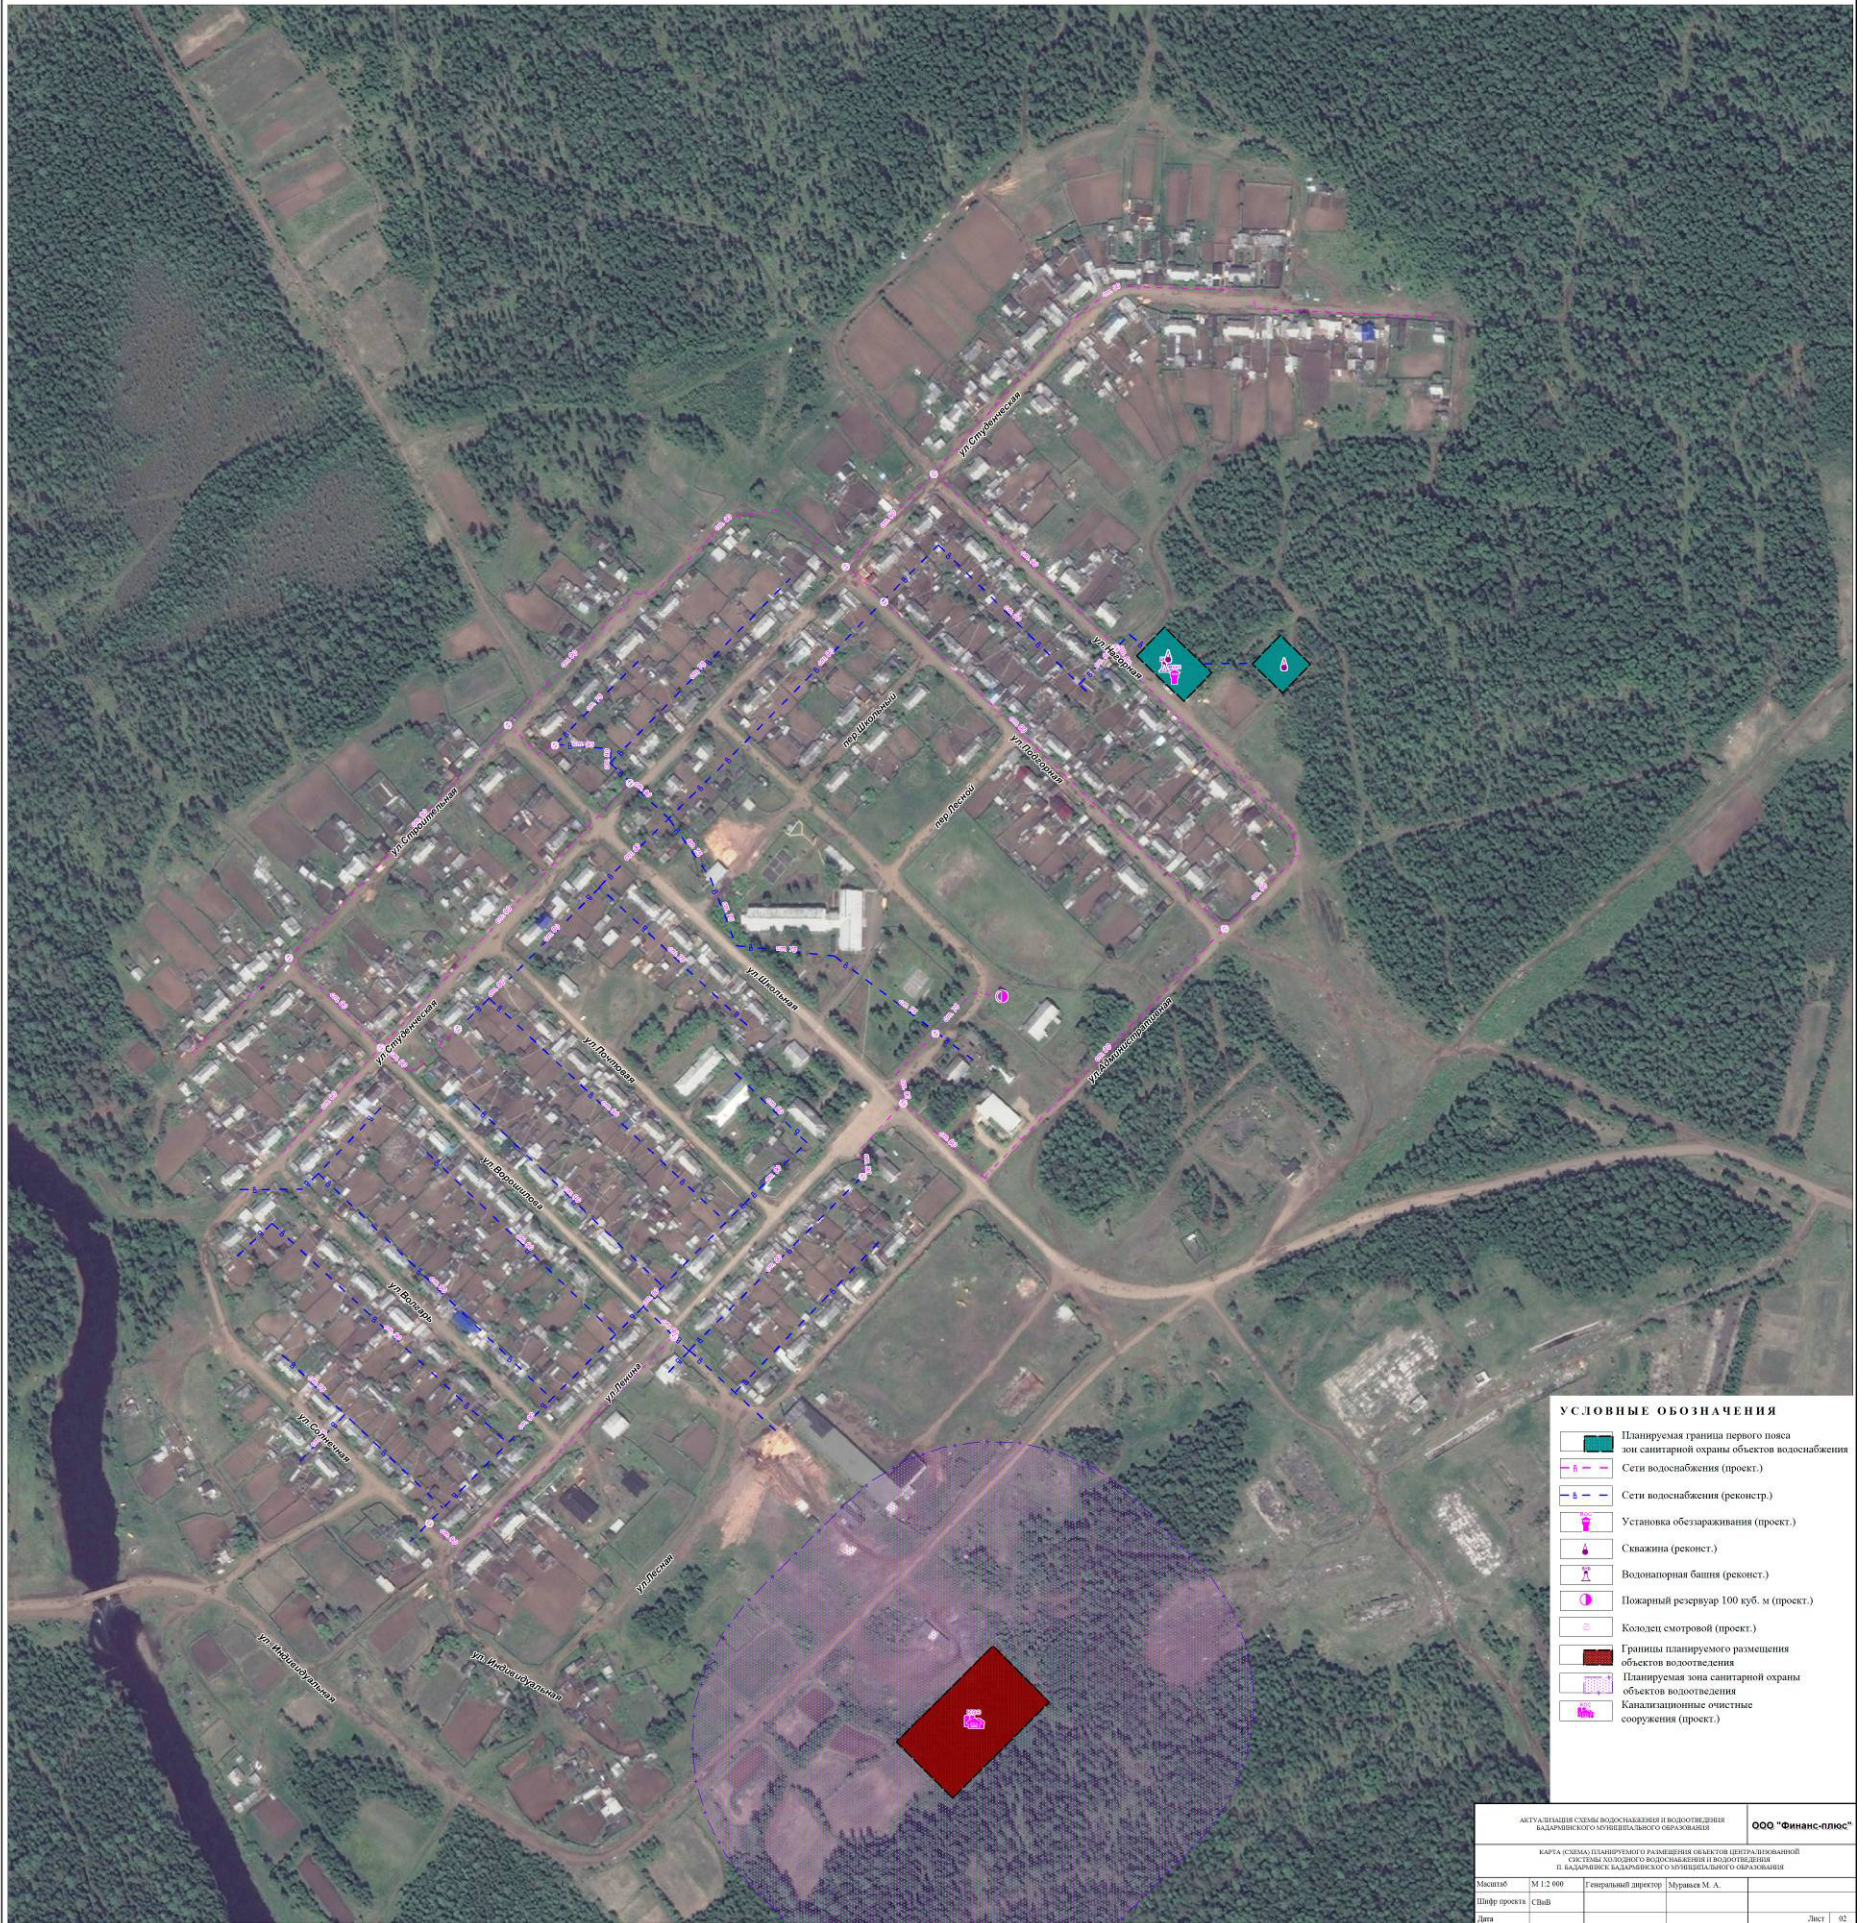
Схема водоотведения п. Бадарминск (проектное положение)
